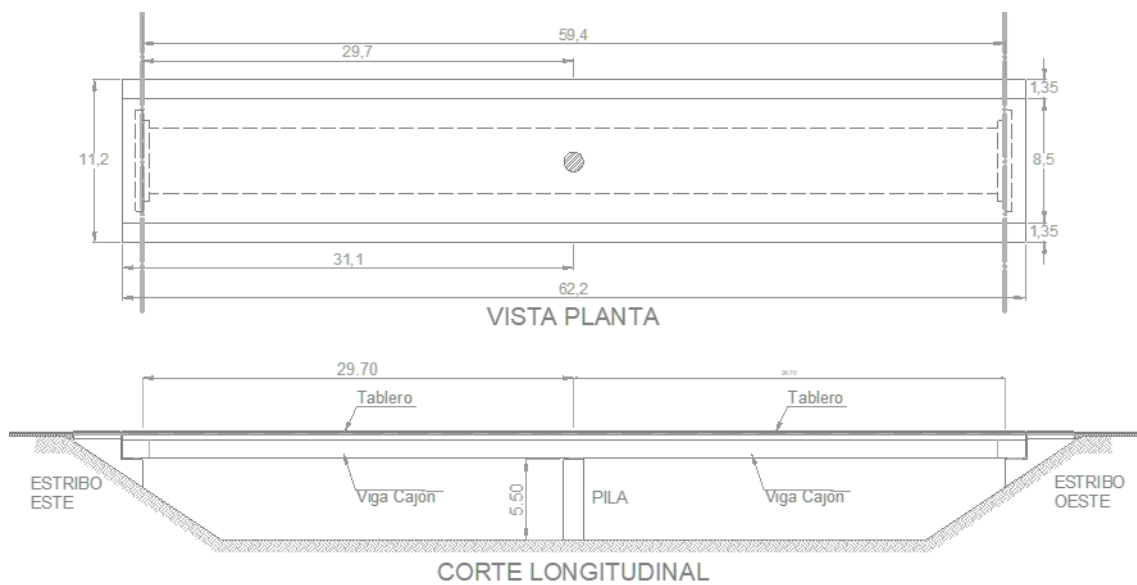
Dimensiones en planta y corte longitudinal, puente calle Boedo. Dimensiones en metros.
